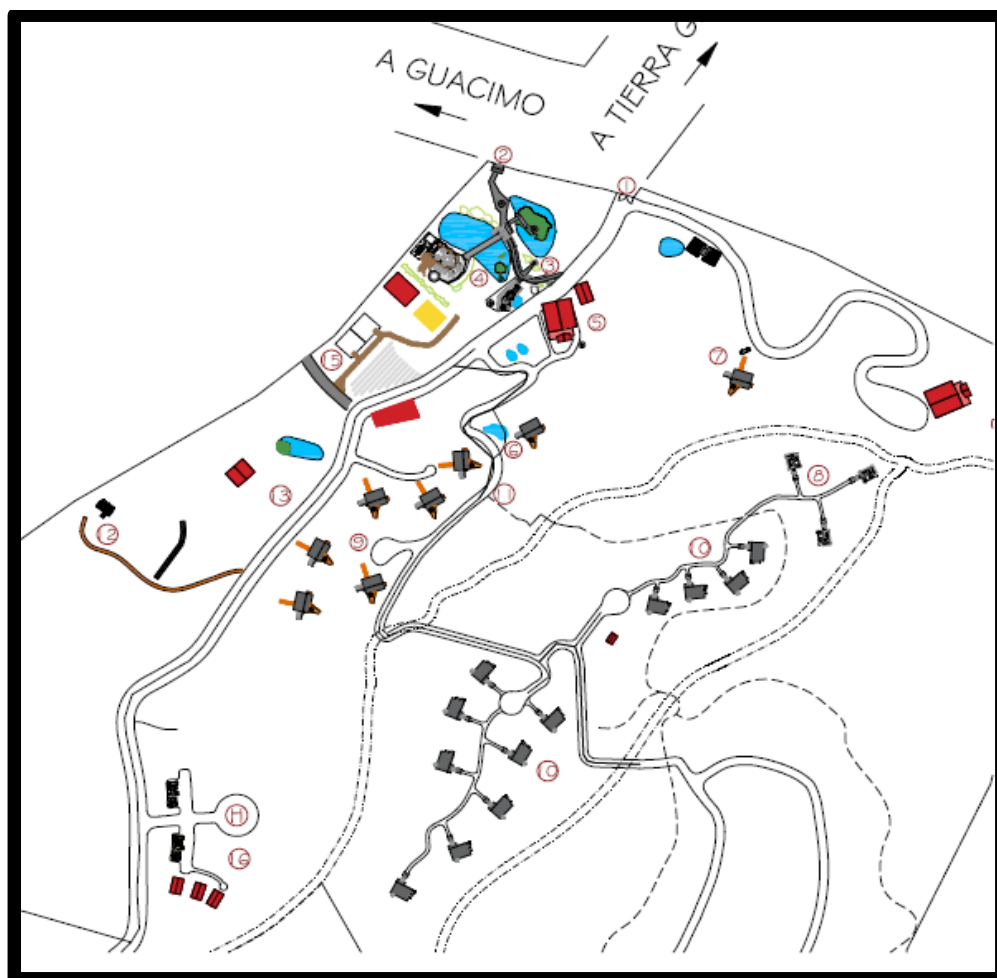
Plano conjunto del Proyecto Hotel Eco Lirios Boutique
